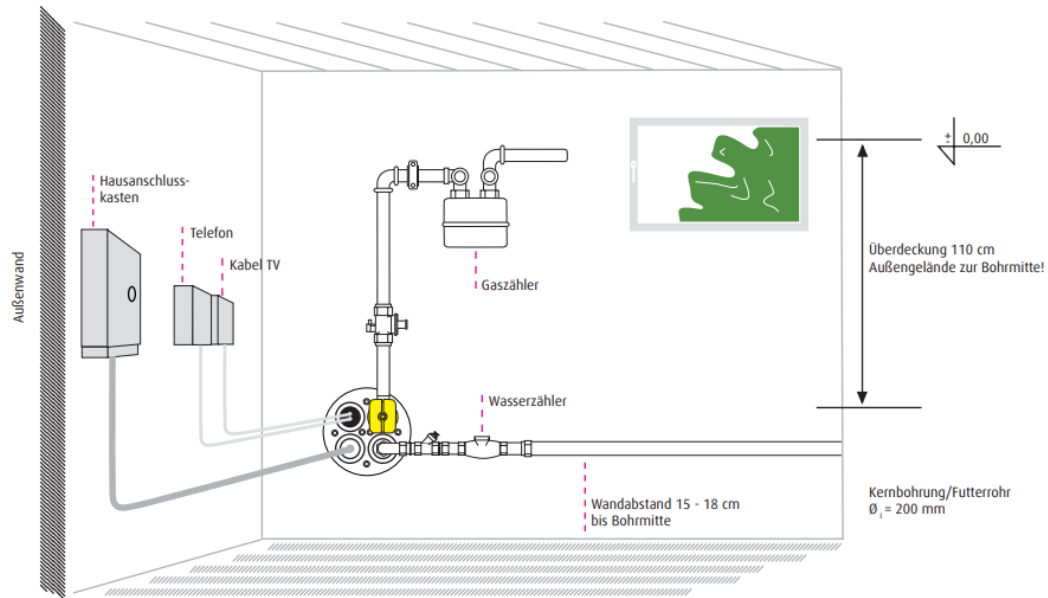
Hausanschlussraum mindestens 1,80 m breit 2,00 m lang und 2,00m hoch
